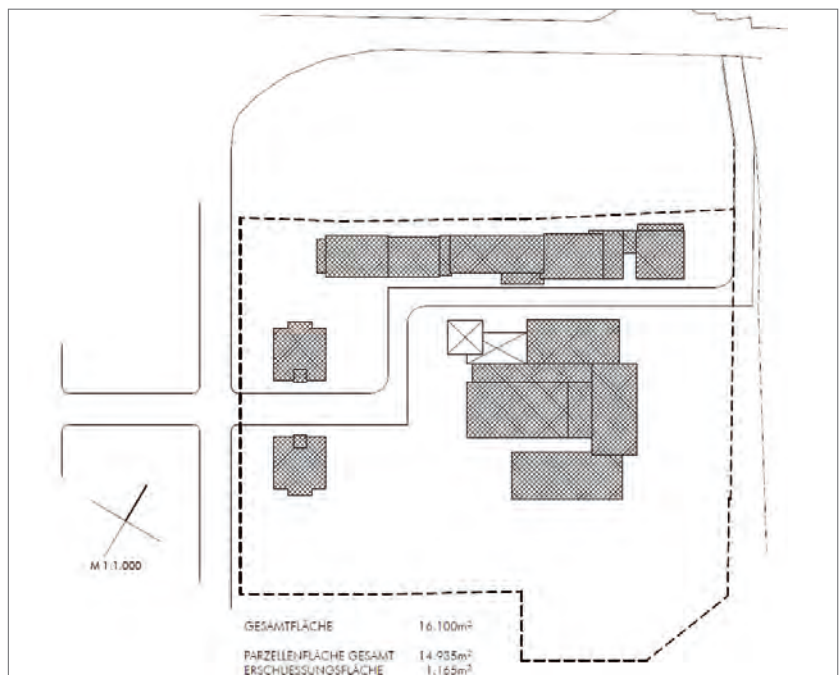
Skizze Erschließung über Privatgrundstücke zur Albanstraße
